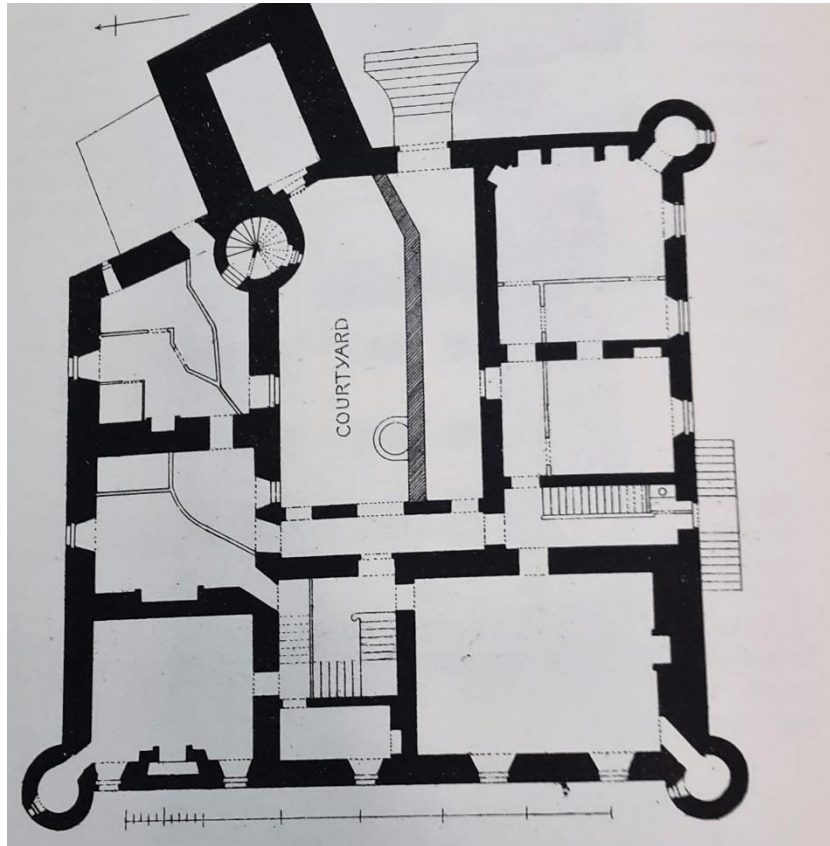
Golspie, Dunrobin Castle (plan du rez-de-chaussée), XVIII^e siècle, James McLeran.
